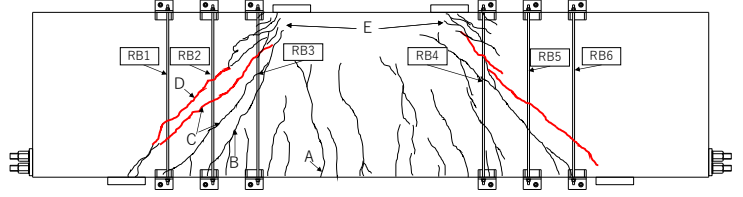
最大荷重時のひび割れ状況（No.2）
